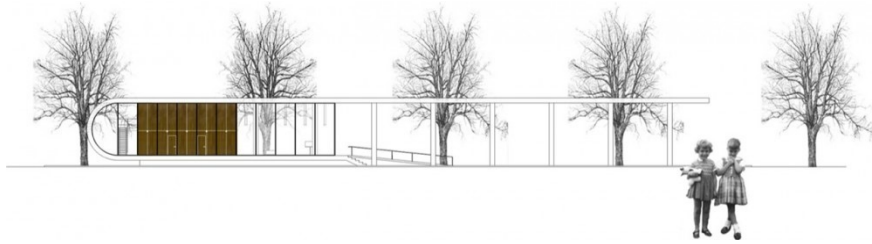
Hall de entrada destacando a estrutura em vidro.
